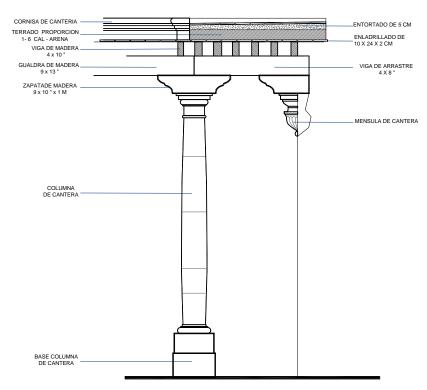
Detalle No. 4 vista del corte del apoyo aislado de la cubierta del corredor.
